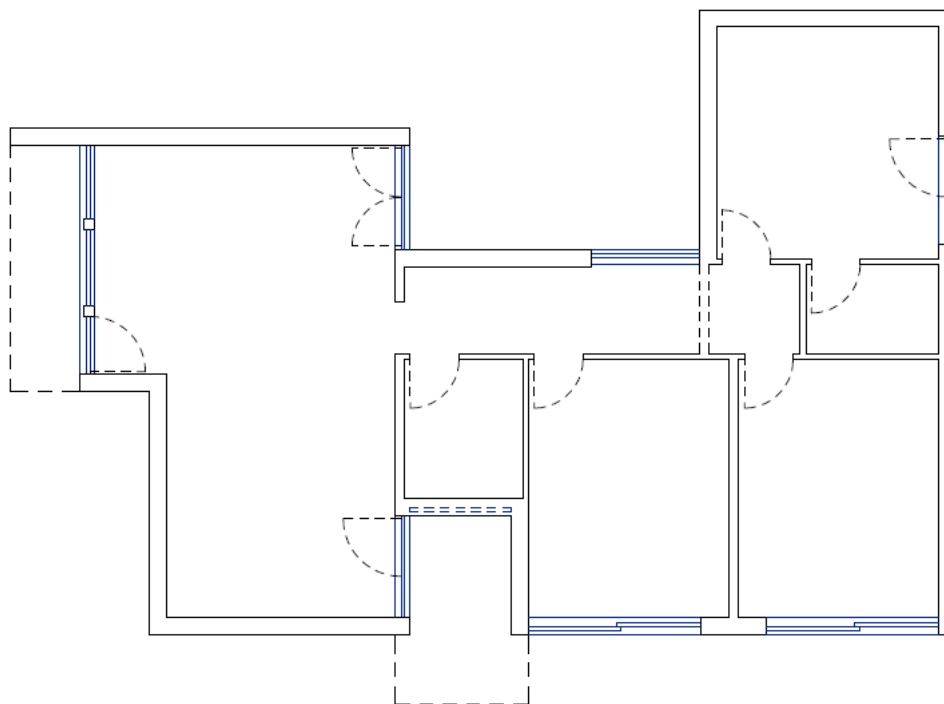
Planta do modelo T3 do ICFs e construção tradicional
